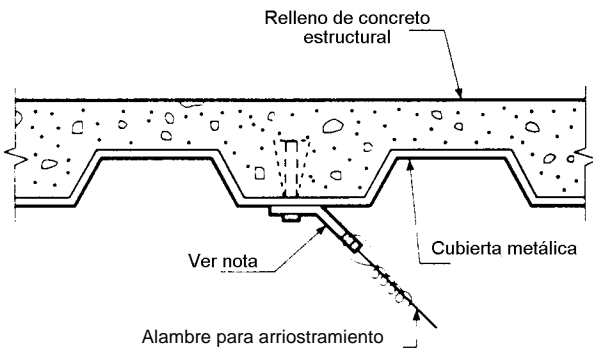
(b) Detalles aceptables: conexiones de alambre a armaduras de acero.
